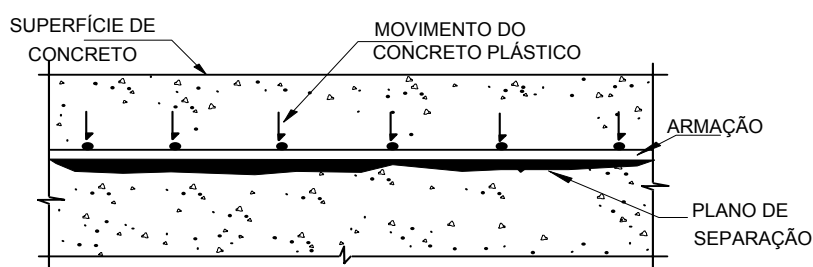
Plano de separação entre o concreto e a armadura causada pelo assentamento plástico
